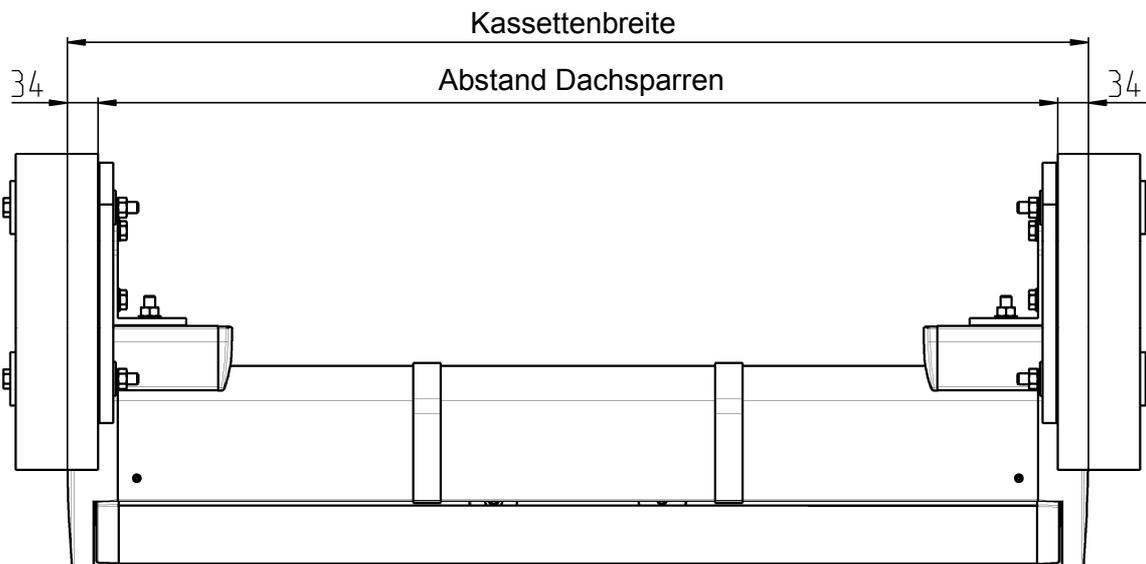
Sondervariante Dachsparrenbefestigung vertauscht mit Dachsparrenhalter und Montageplatte
